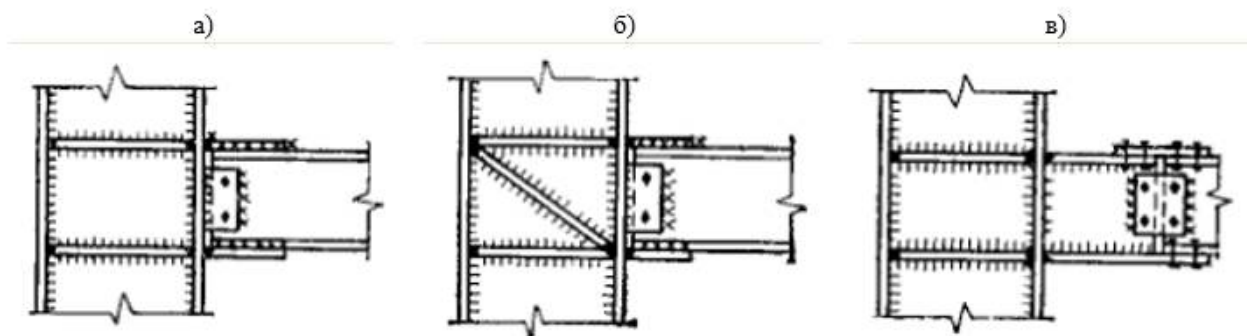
Жесткое сопряжение балок с колоннами на сварке:
